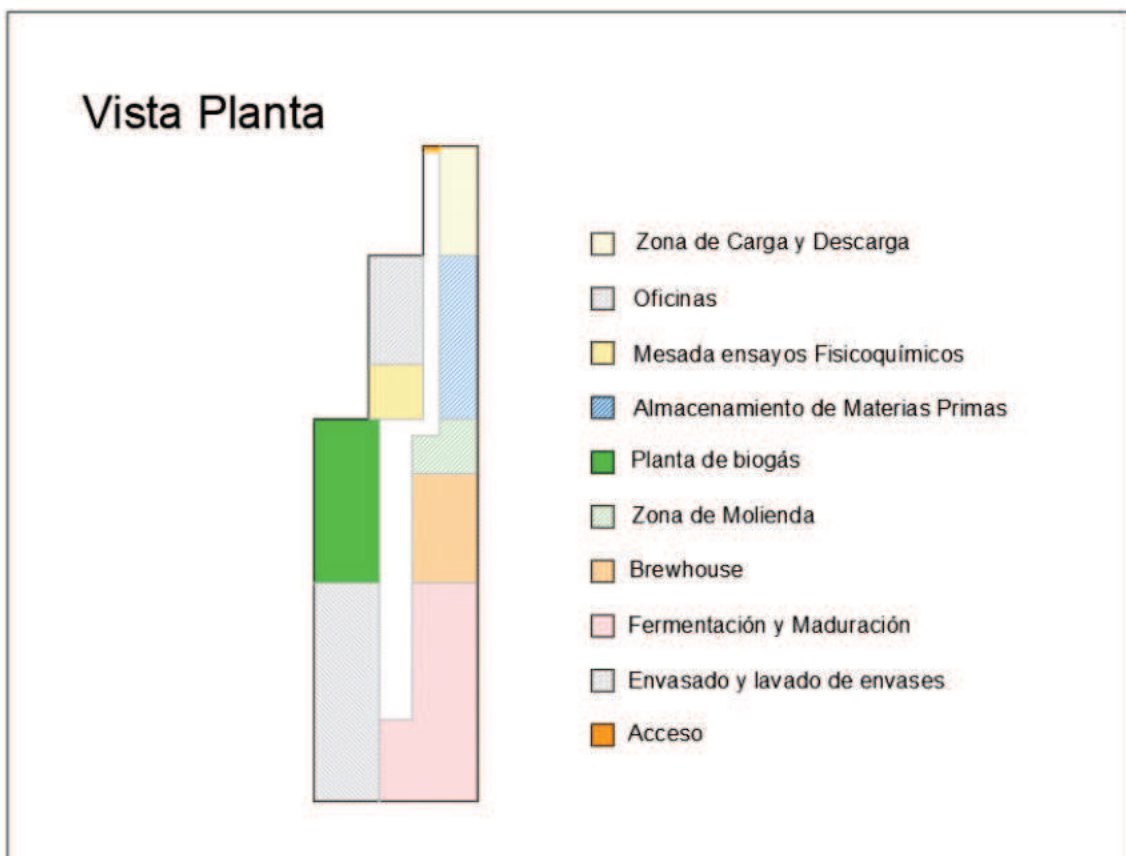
Vista planta del caso de estudio con planta de biogás
